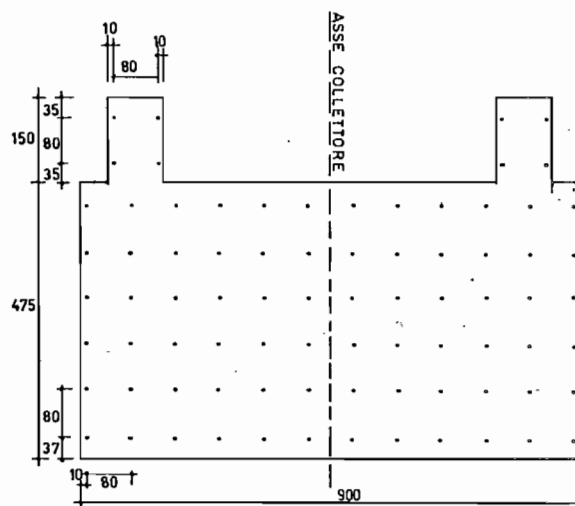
Stralcio planimetrico del secondo intervento di consolidamento.
